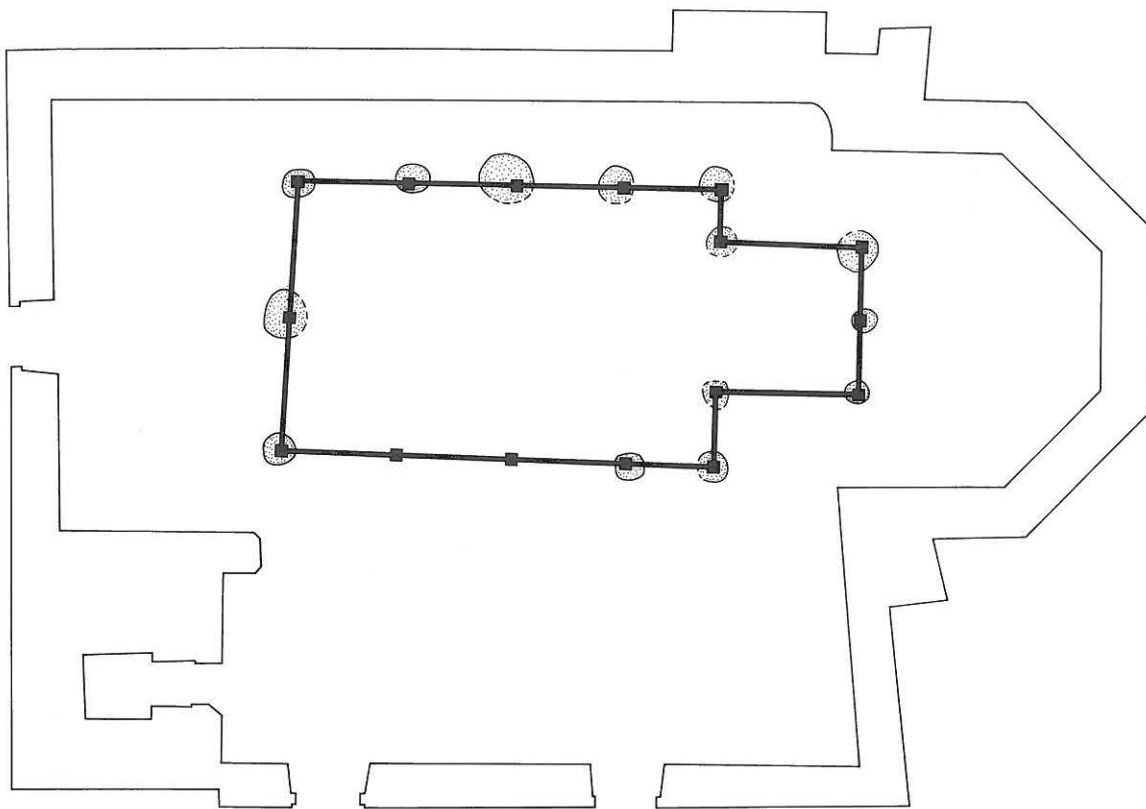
Rekonstruktion des Grundrisses der Holzkirche I B. M. 1:150.
